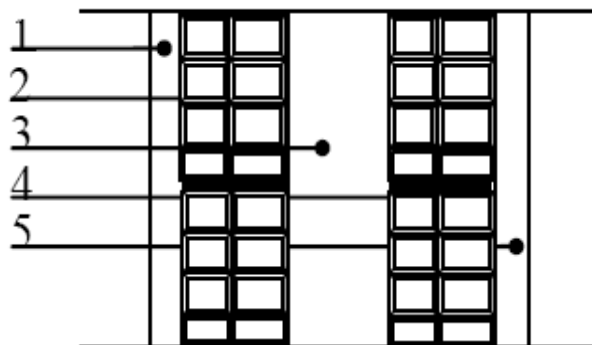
A) Coupe verticale d'un mur extérieur.
